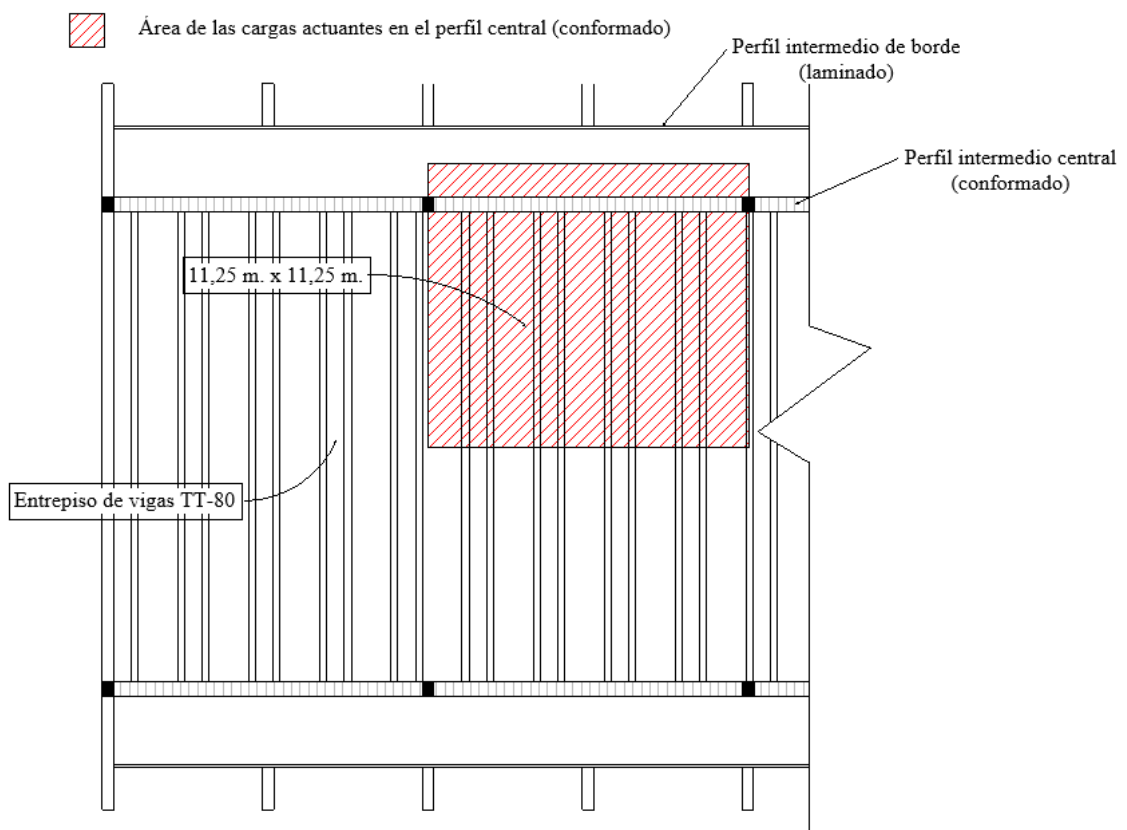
Vista en planta de la superficie de carga actuante sobre perfil central. Fuente: Autor.
